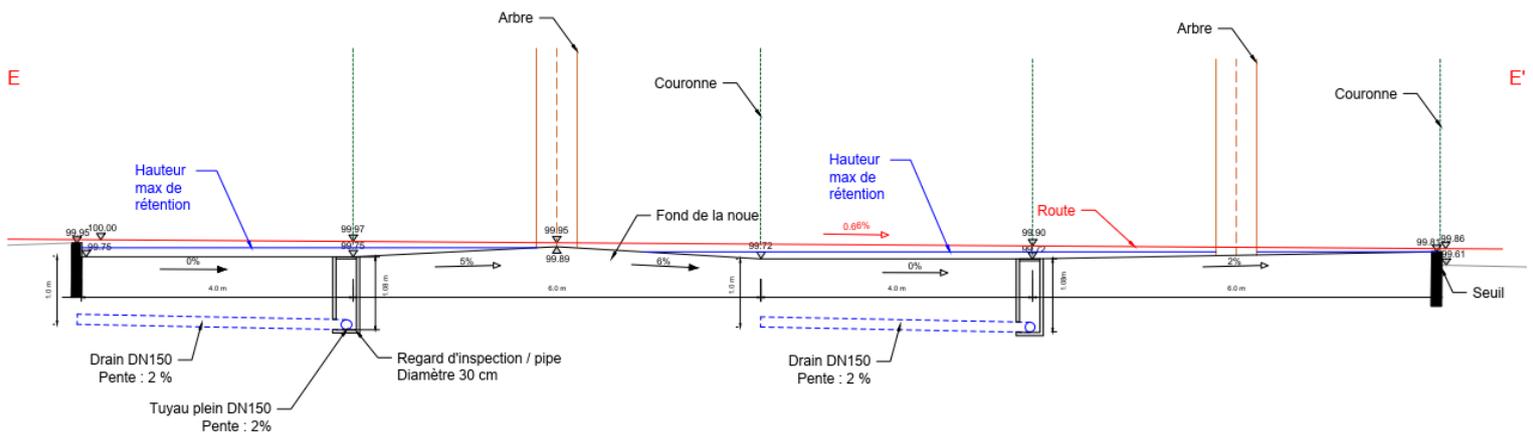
Schéma de fonctionnement hydraulique du système de gestion des eaux de chaussée - Profil en long E-E'
